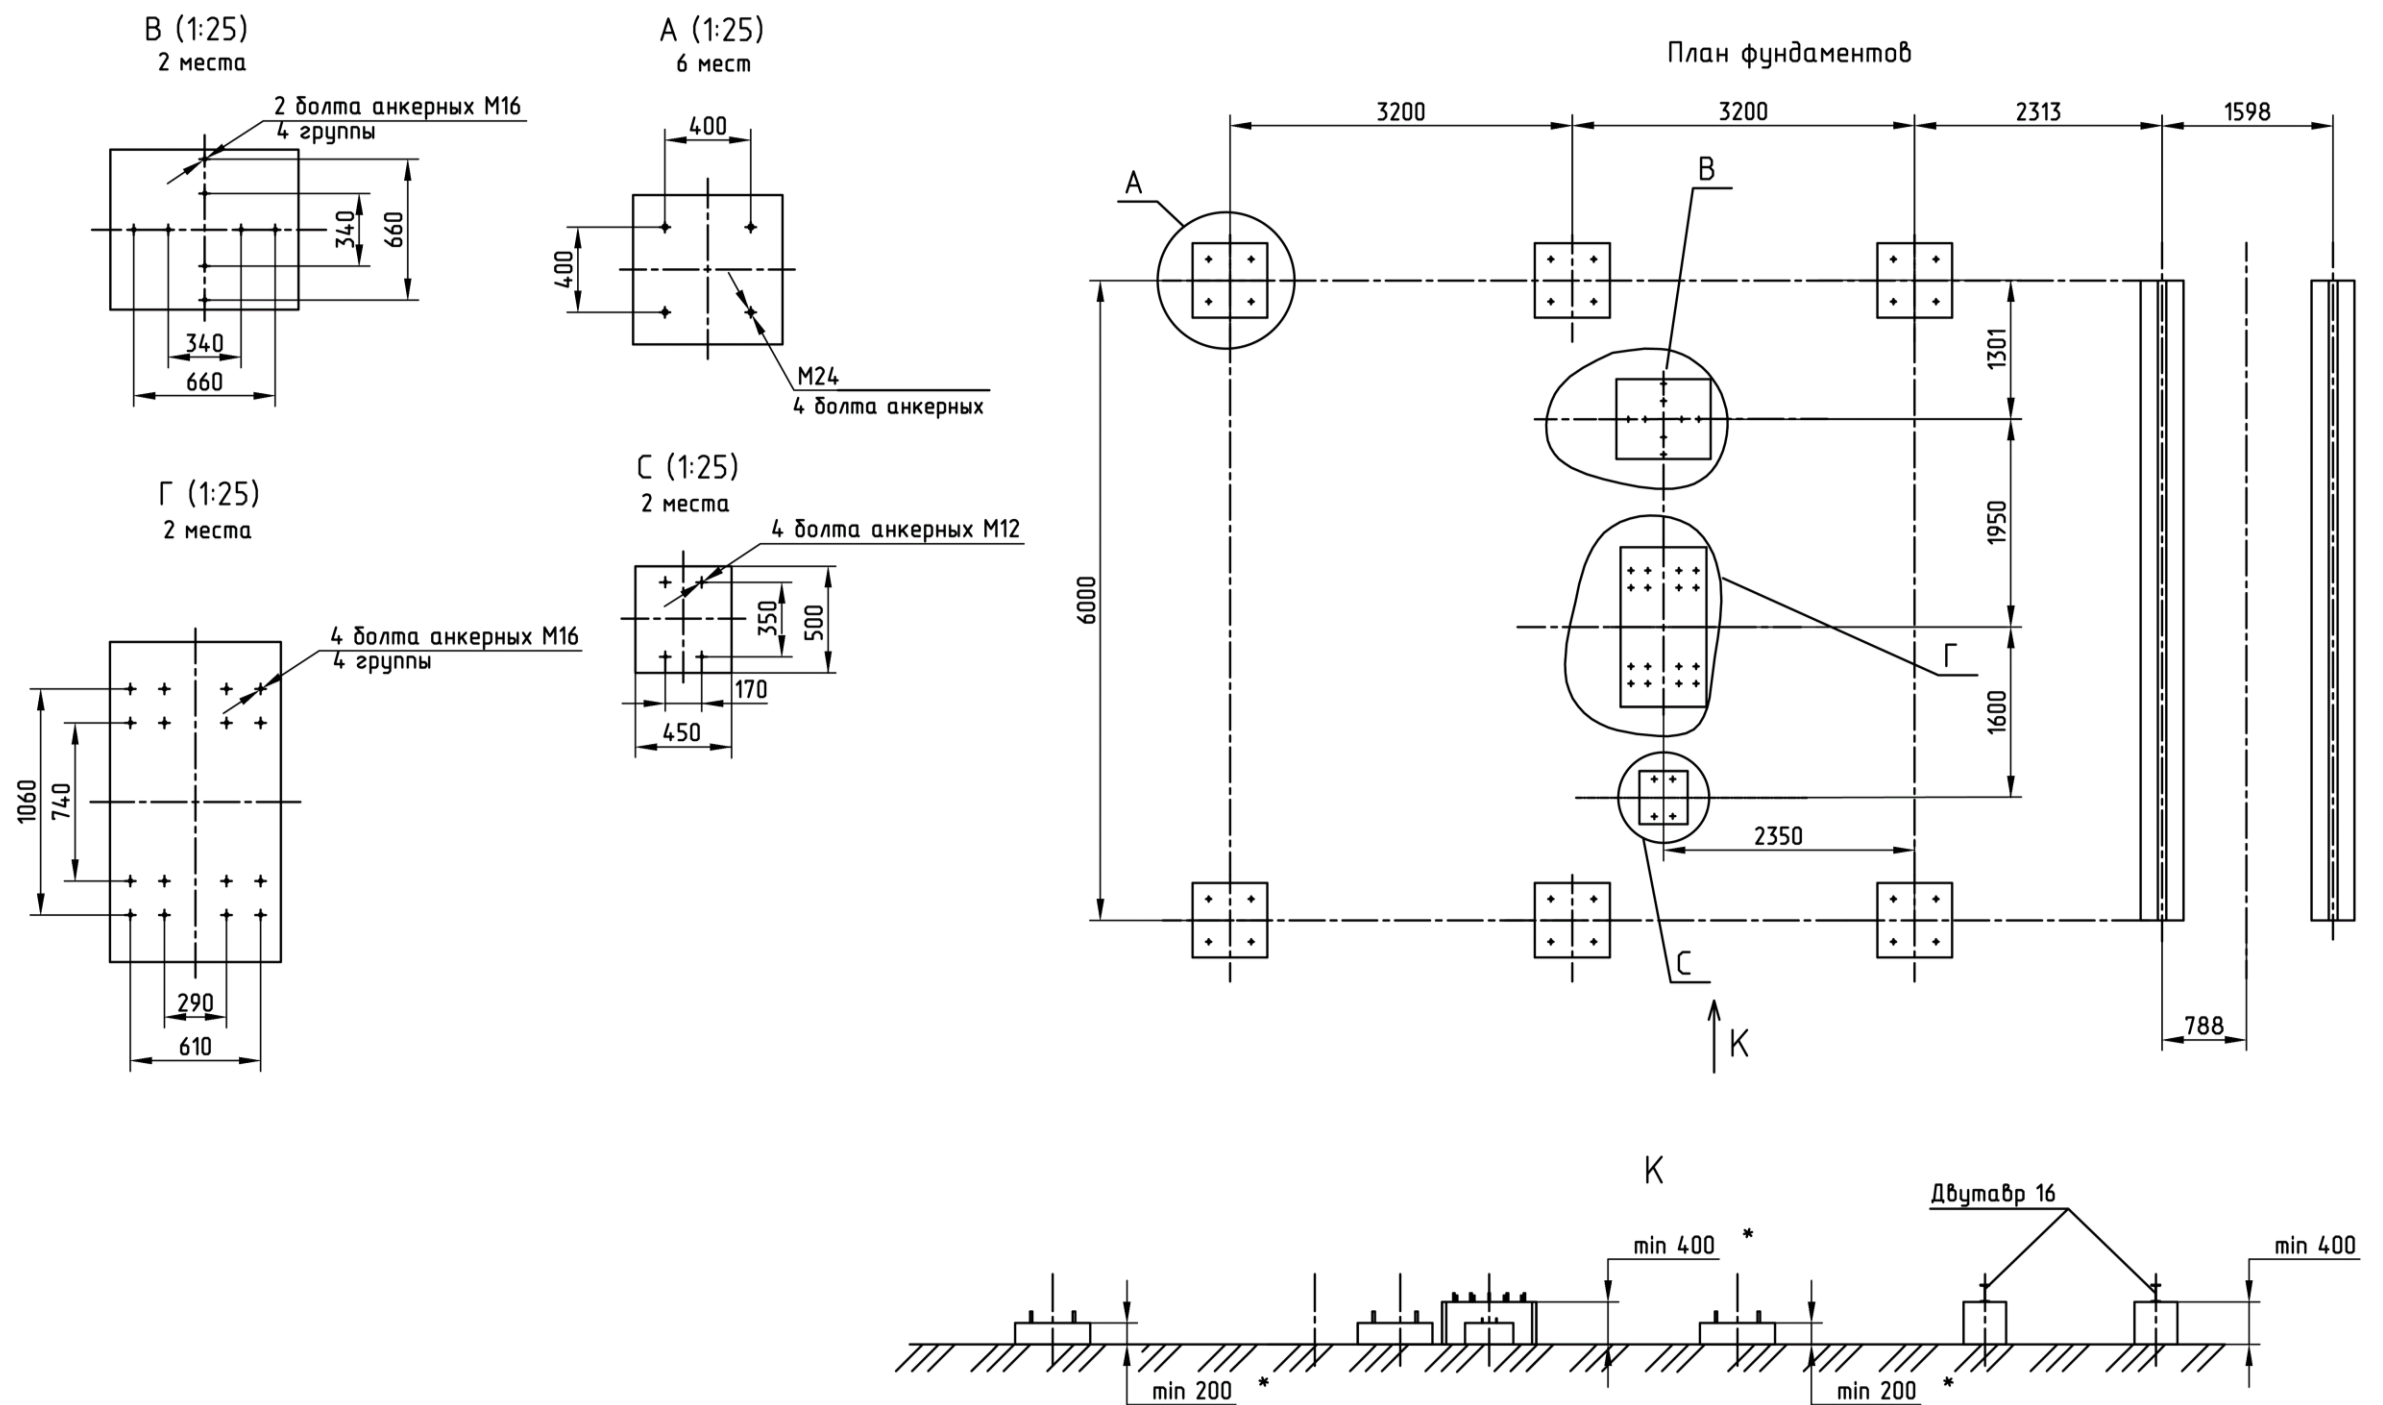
План фундамента для УПК-25 кВ-800 А У1
